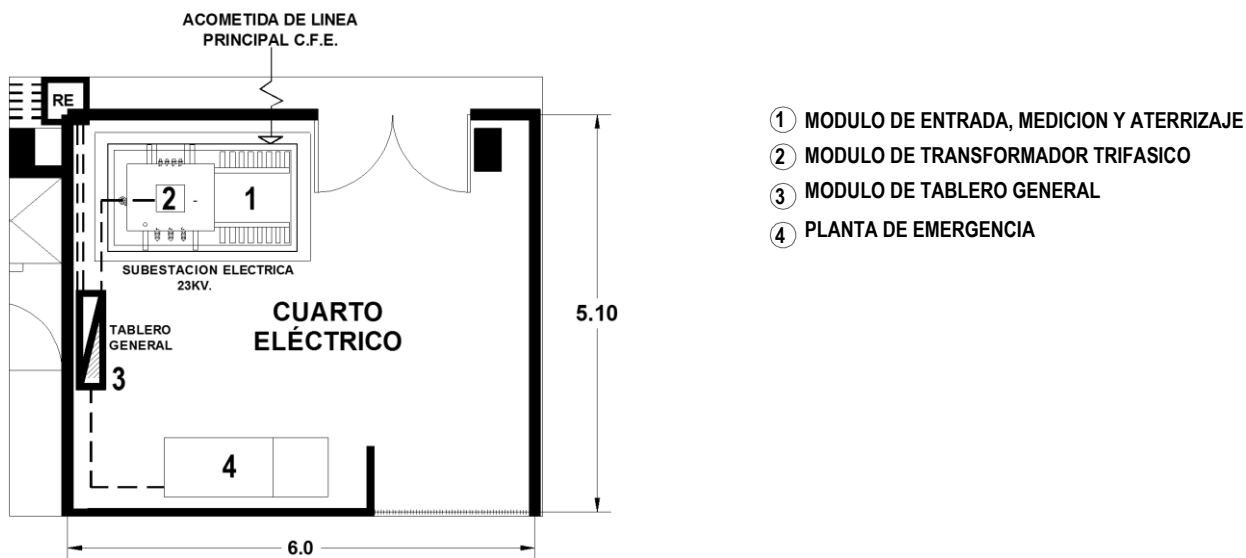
ESQUEMA PLANTA DE CUARTO ELÉCTRICO
